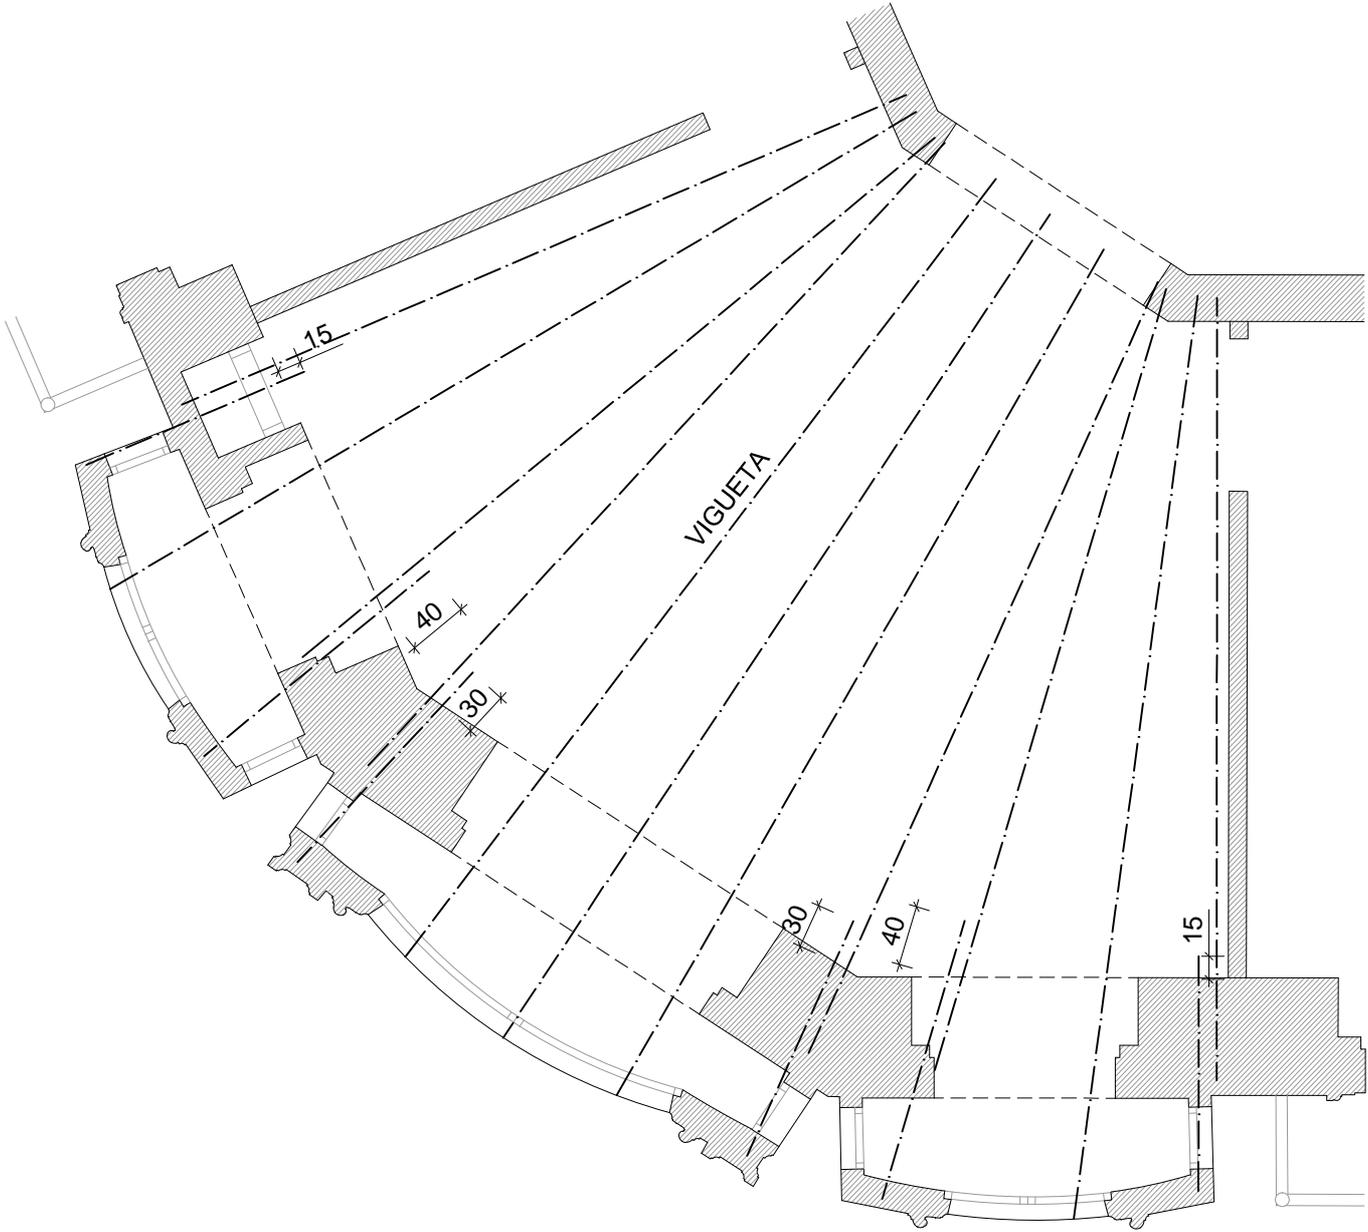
DISTRIBUCIÓN DE VIGUETAS EN CHAFLÁN. TECHO PLANTA PRIMERA
